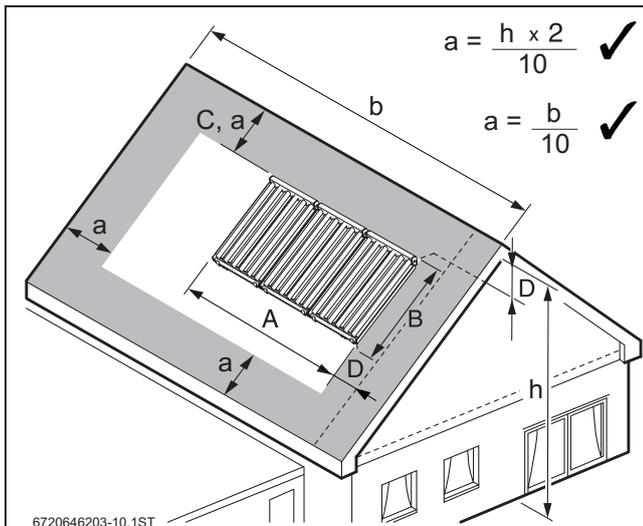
Fabbisogno di spazio per il montaggio sopra tetto di collettori a tubi sottovuoto SKR
